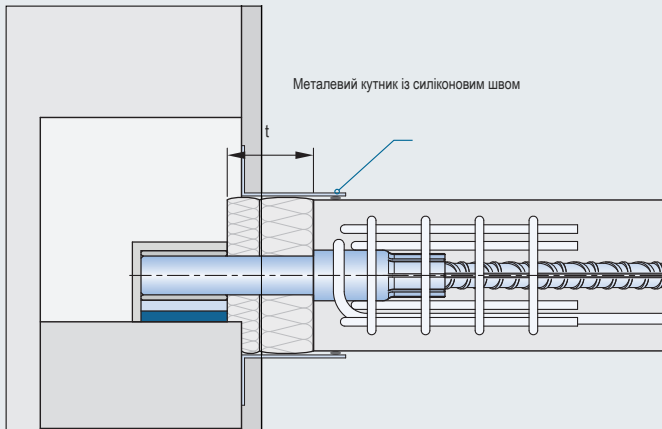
Багаторазове розташування протипожежної манжети за великої ширини шва
